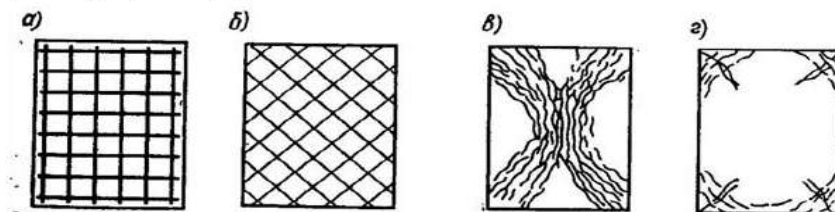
Схемы армирования и характер разрушения при испытании плит, опертых по контуру
